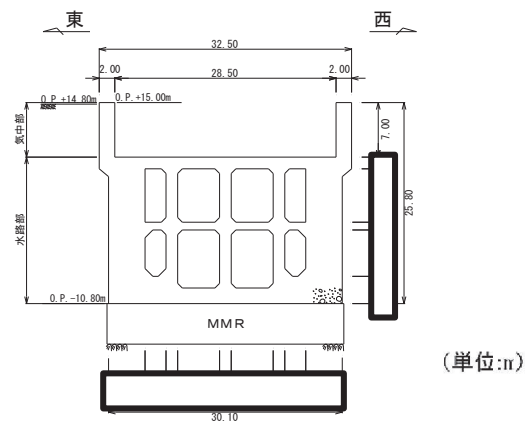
海水ポンプ室断面図 (A-A 断面, 東西 (スクリーンエリア))
